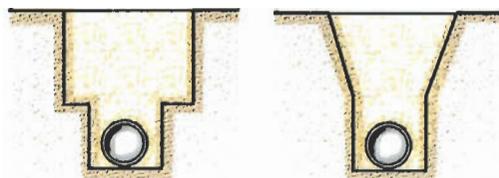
b Instalación en subzanja en una zanja ancha
